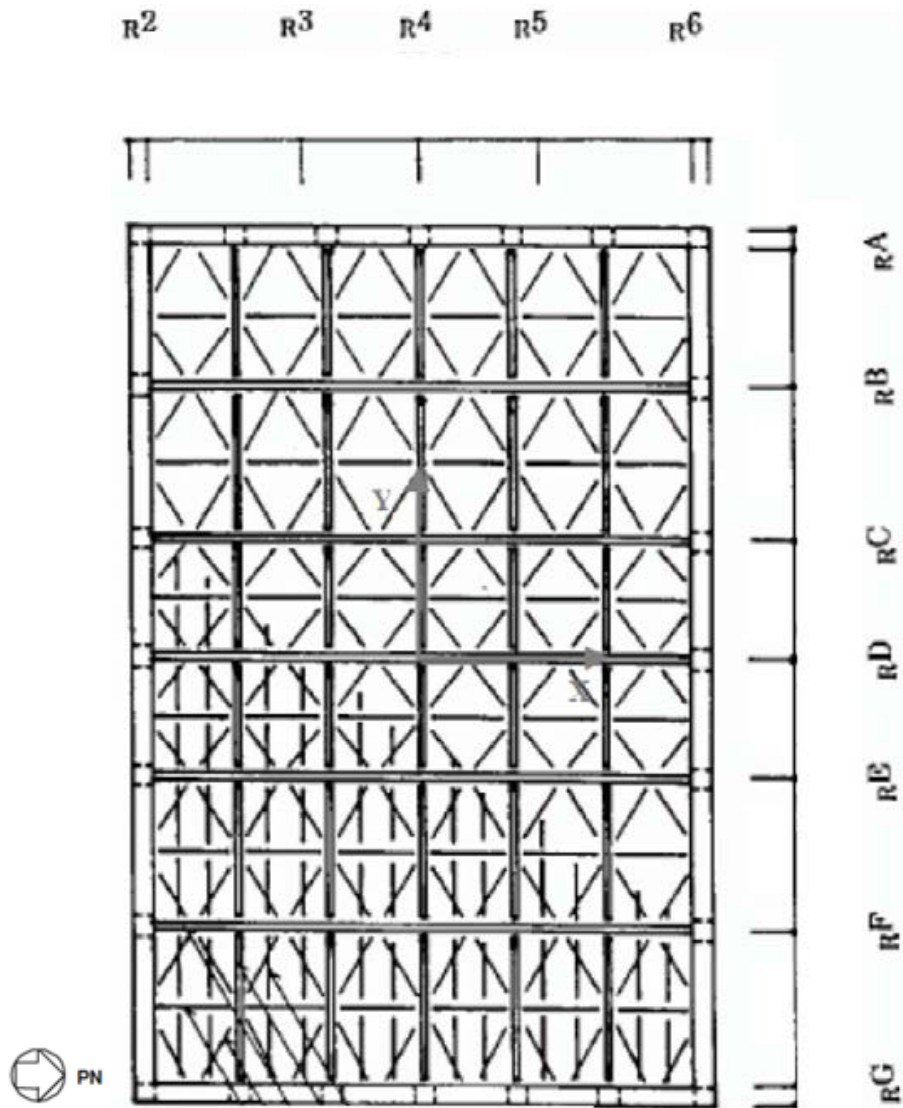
屋根トラスの平面図（屋根、標高 +49.7m）
